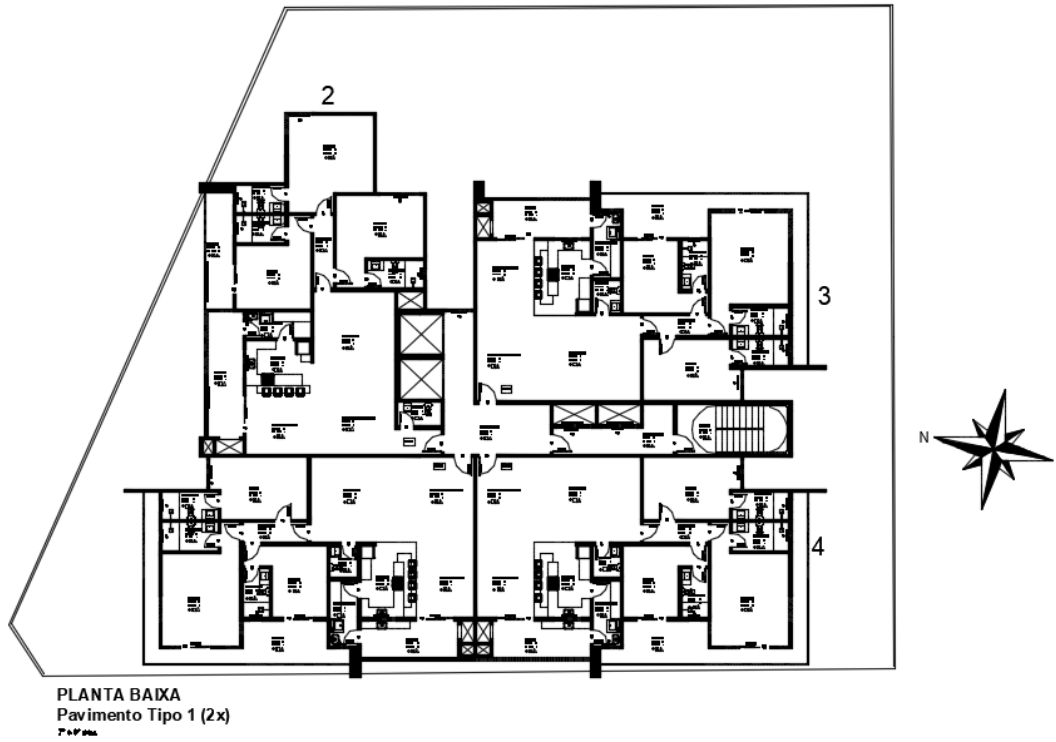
Projeto Arquitetônico – APARTAMENTO TIPO 1
